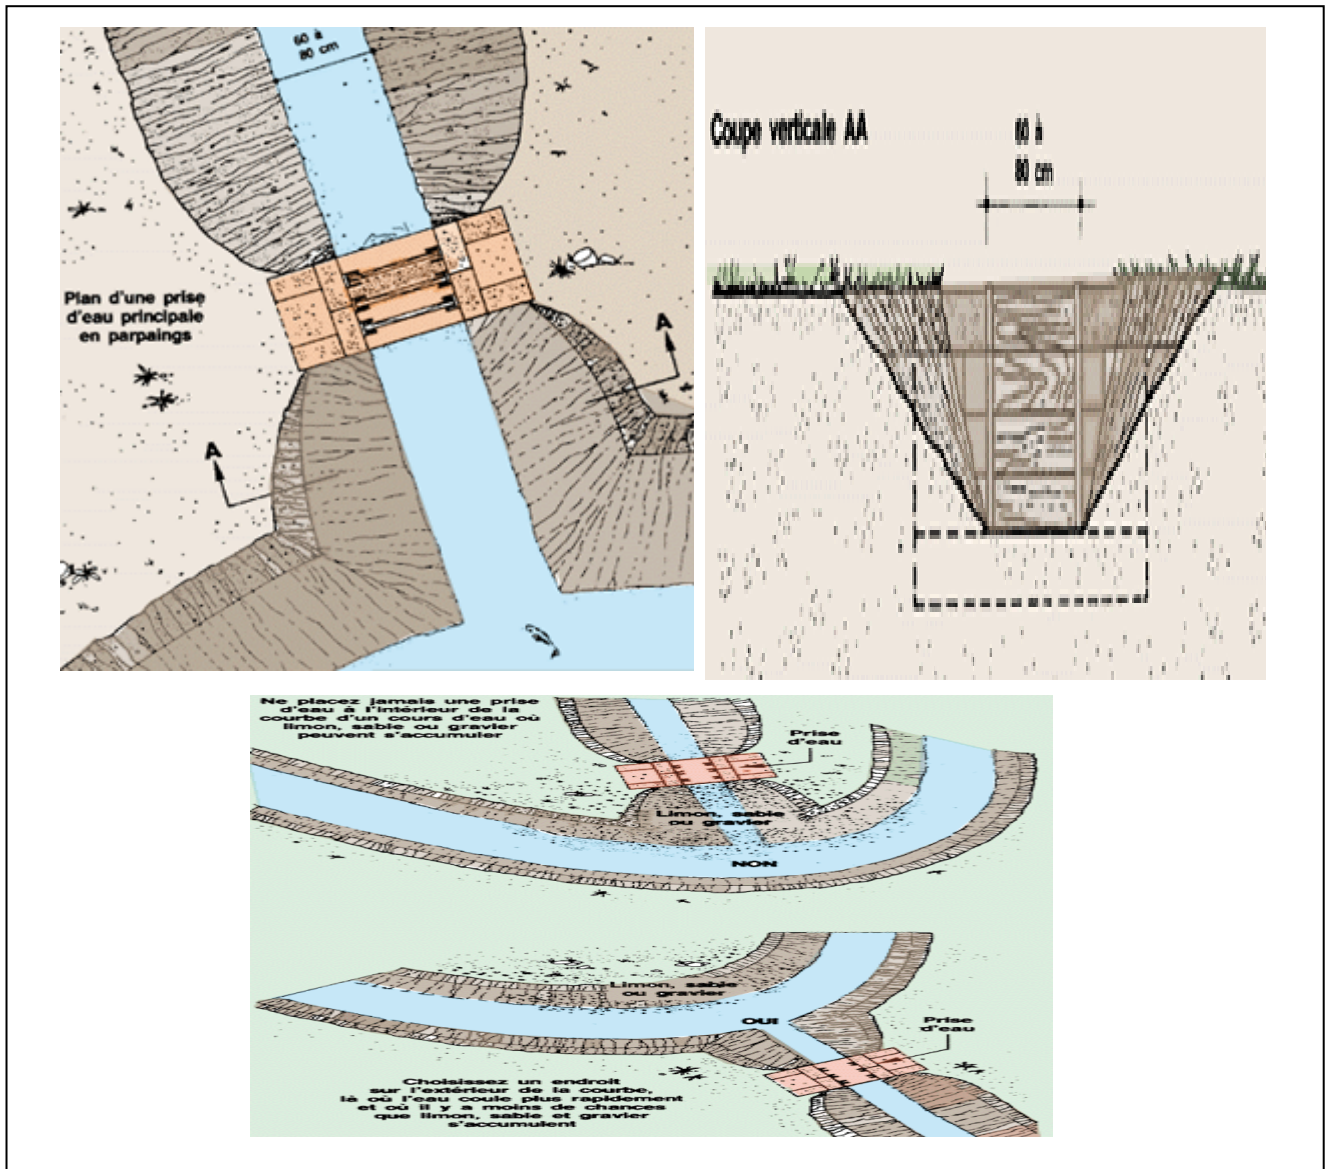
Choix du site de la prise d'eau principale le long d'un cours d'eau
